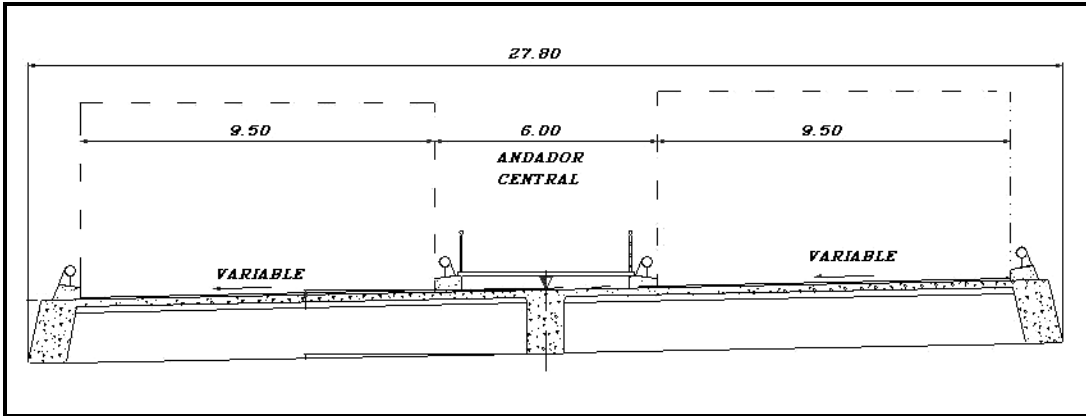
Sección transversal Tablero del Puente con parapetos y andador central
